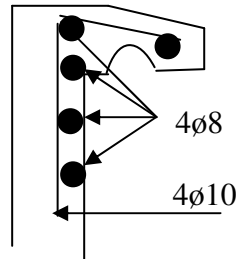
d : Schéma de ferrailage de l'acrotère
